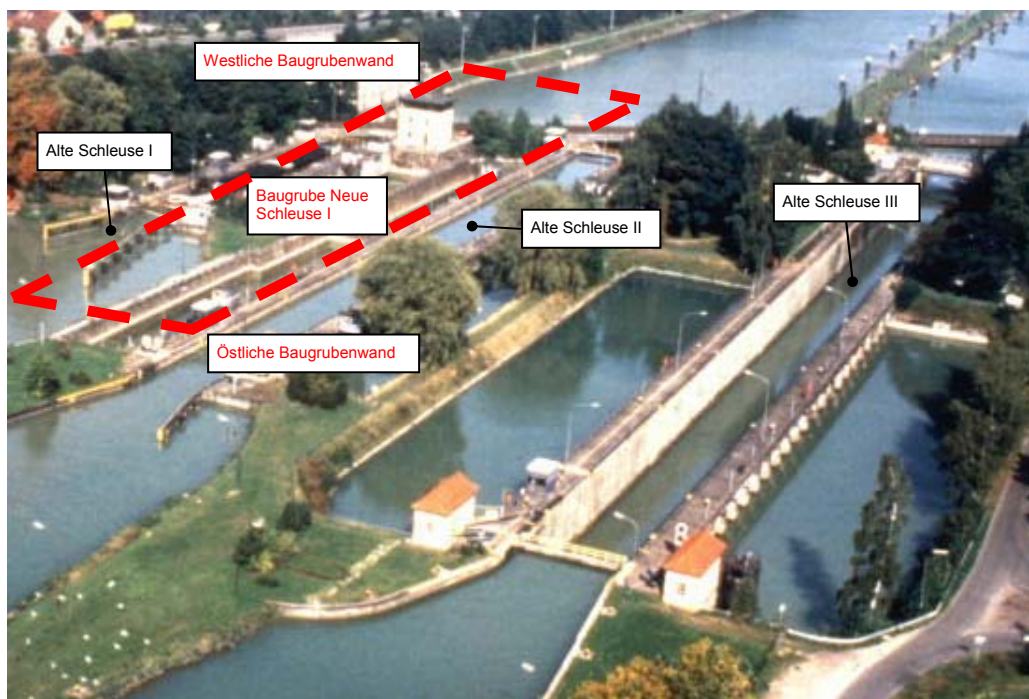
Schleusenanlage Münster mit Lage der Baugrube
